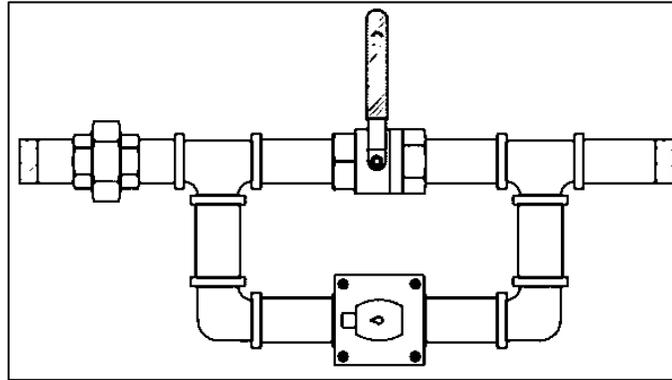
Ejemplo de diseño incompleto de tubería por falta de drenajes en punto muerto. (Vista elevación).
